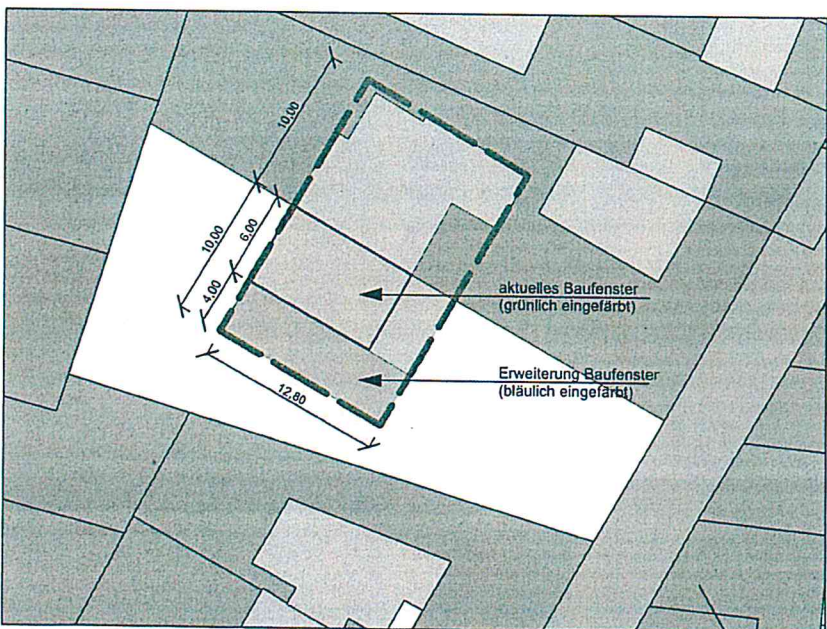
Erweiterung des Baufensters um 4.0m nach Südwesten)
